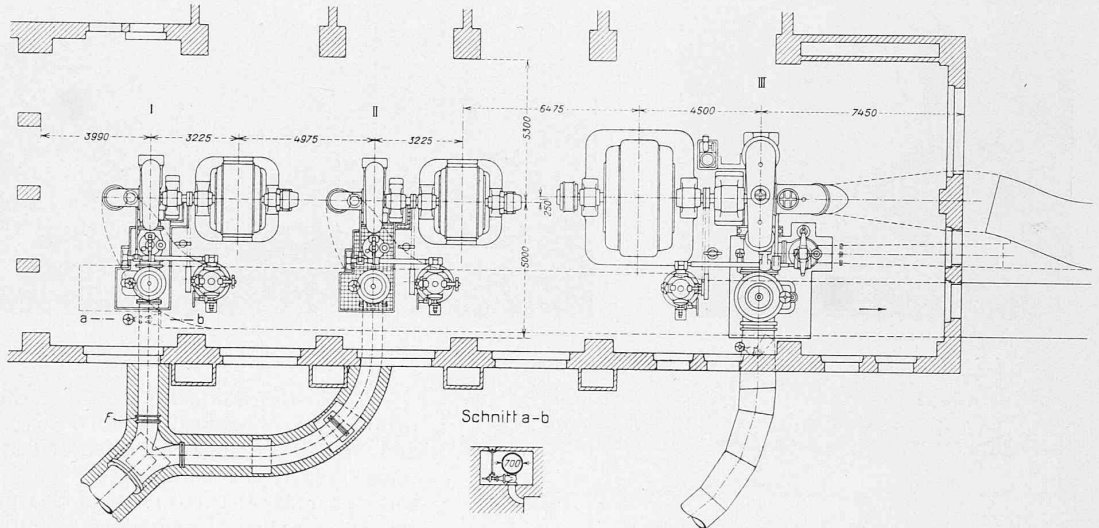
Grundriss des Maschinenhauses des Lungernsee-Kraftwerkes, nach dem zweiten Ausbau. — Masstab 1 : 250.
